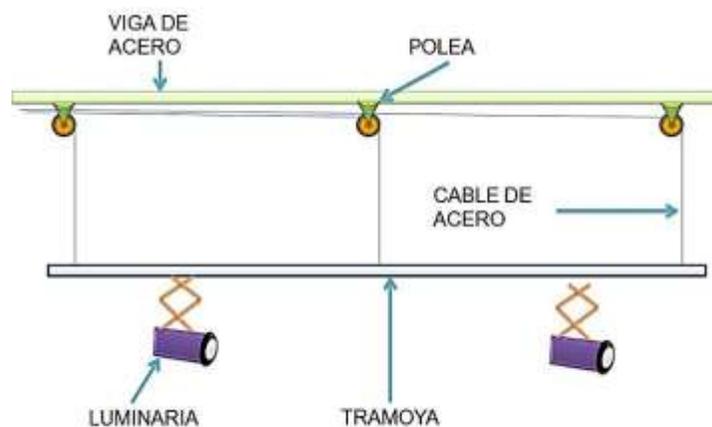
Vista del cable de acero que sujeta a la tramoja
